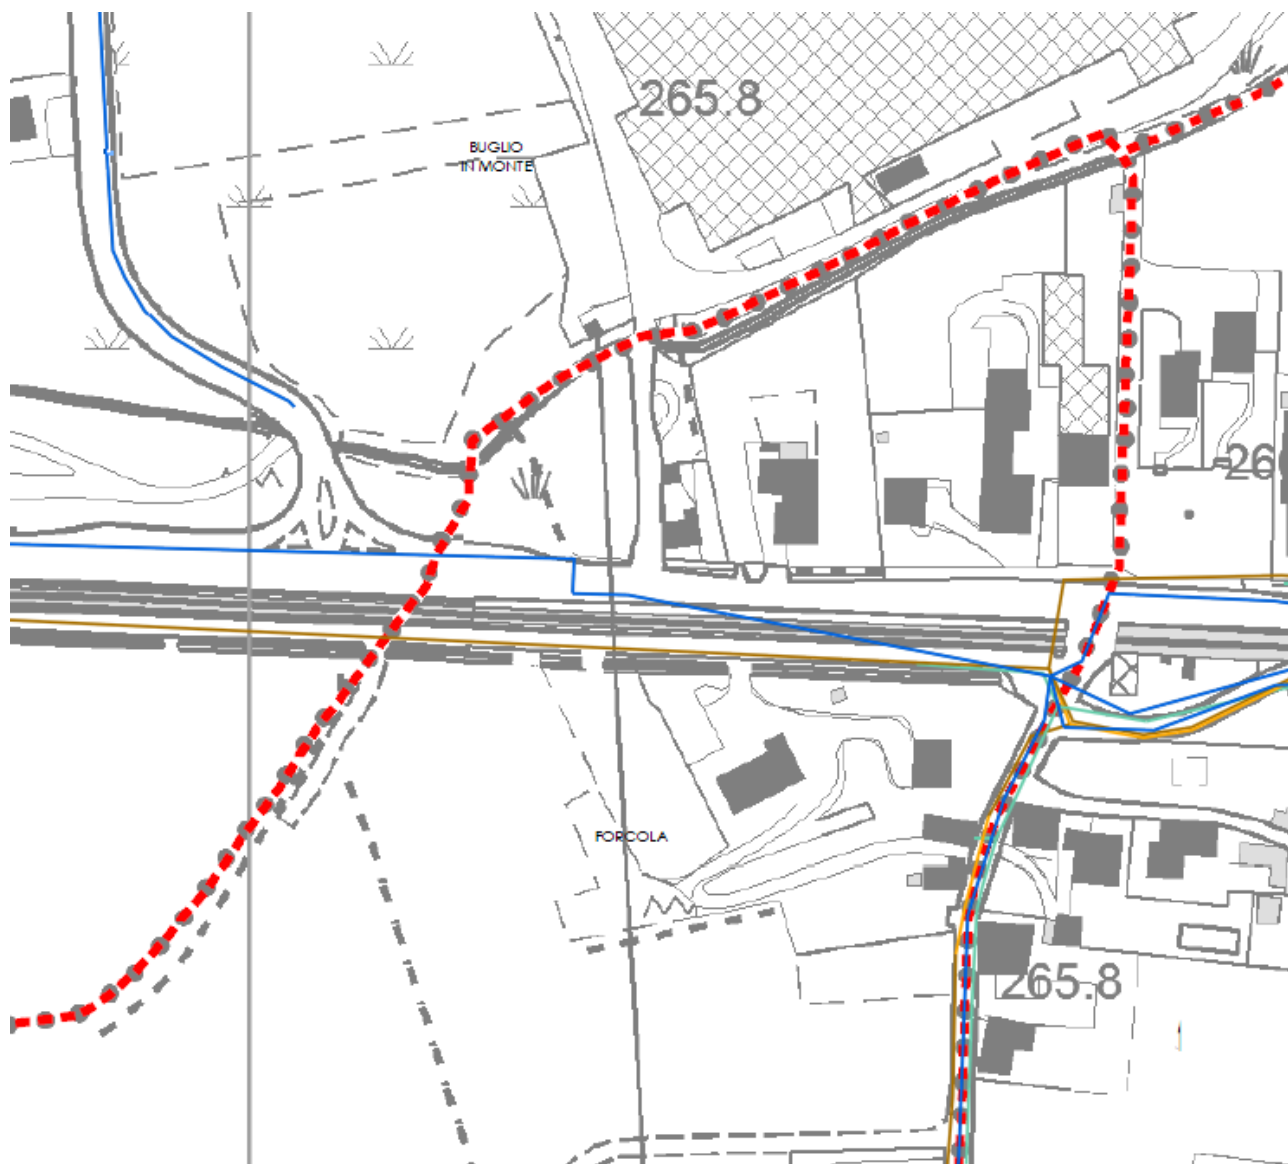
Tracciato rete elettrica inviato dall'Ente
